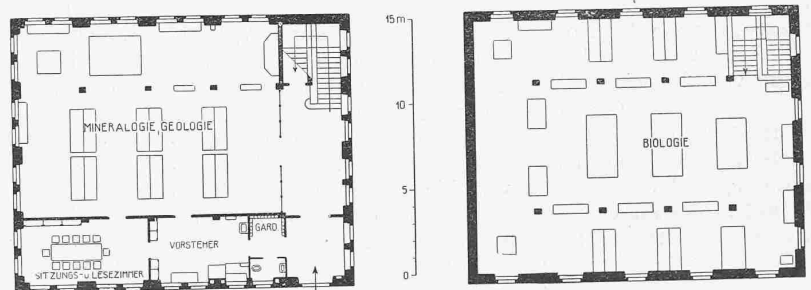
und 3. Grundrisse des Erdgeschosses und des ersten Stocks. — Masstab 1:400.
